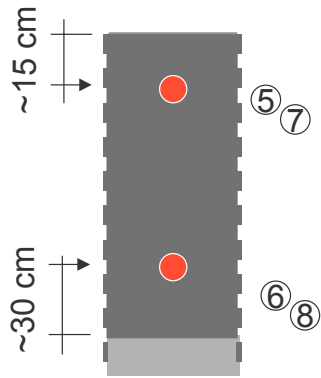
Bohrkern Wand 1, Pos. 4 - Detail
